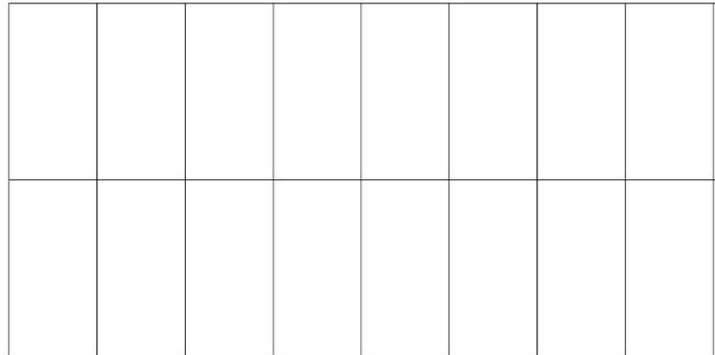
Esquema disposición paneles en planta de techumbre. Fuente: Elaboración propia.
